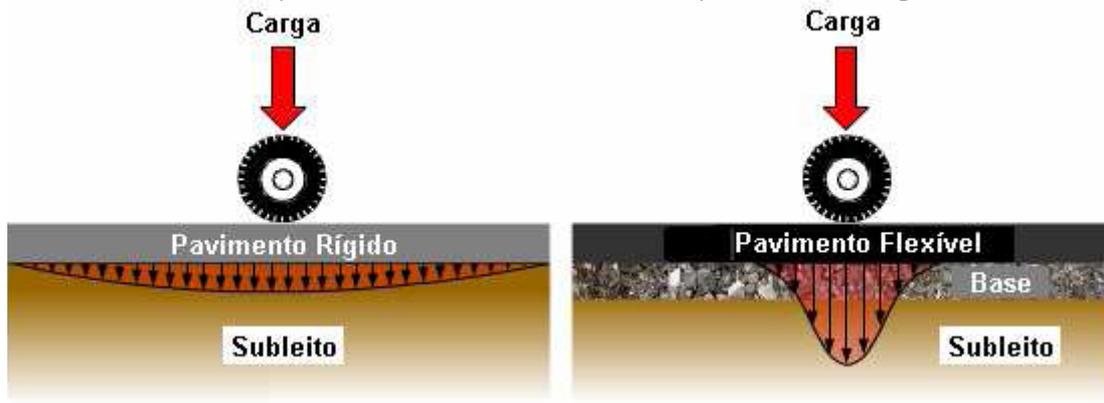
Distribuição de cargas nos pavimentos rígido e flexível.
